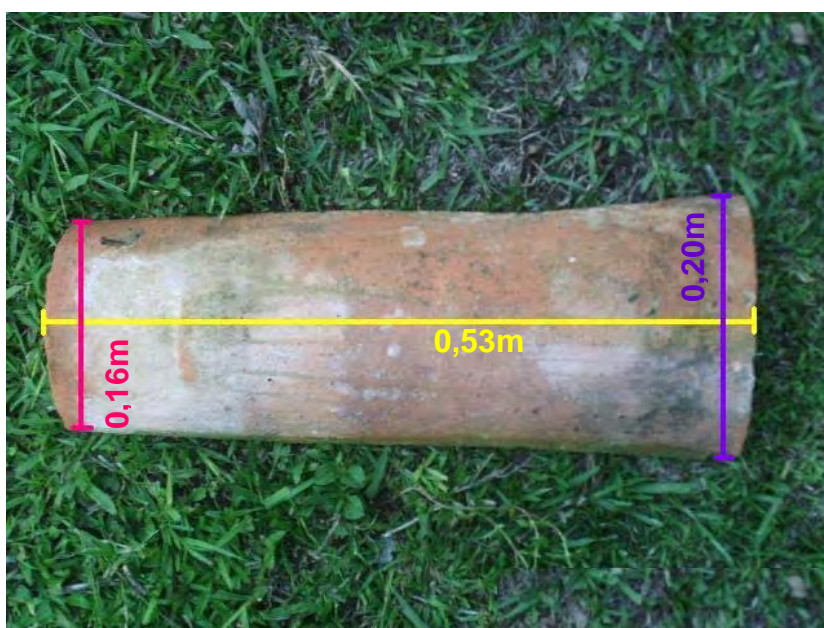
Telha empregada nas construções da estância Vista Alegre.
